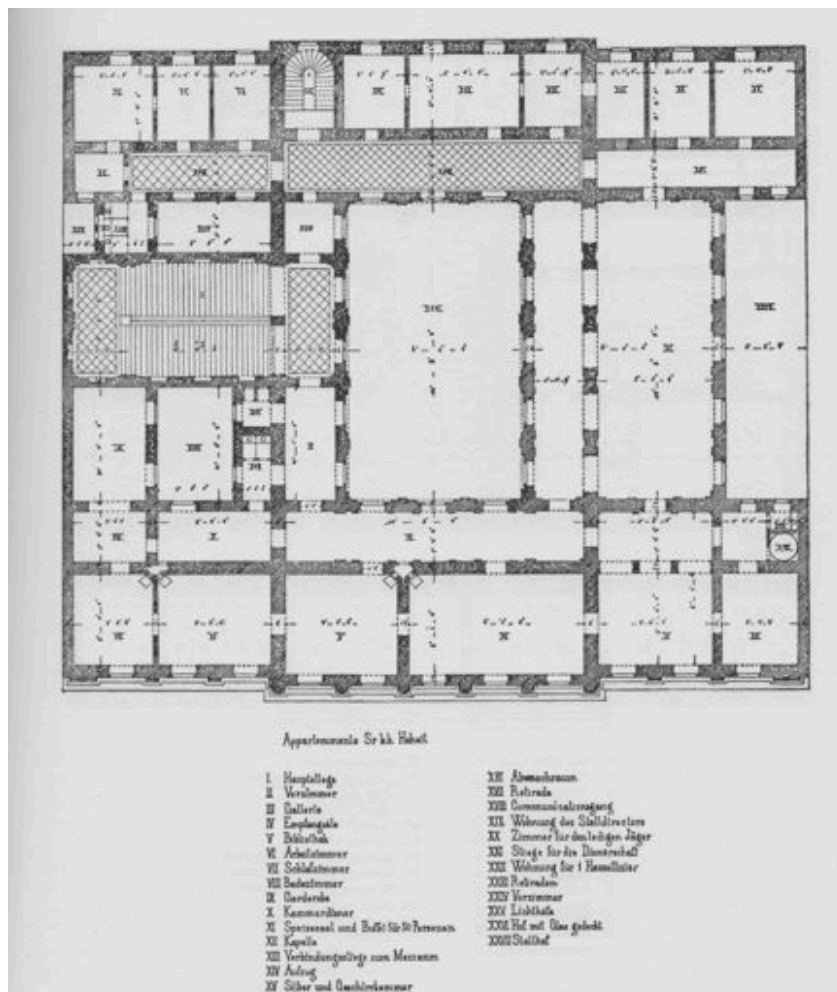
Theophil Hansen, Palais Erzherzog Wilhelm Grundriss 1. Stock, 1. Planphase, nach Reissberger.
